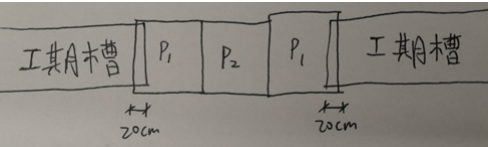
新型抓取式接头示意图（II 期槽先施工 P1 后施工 P2）
